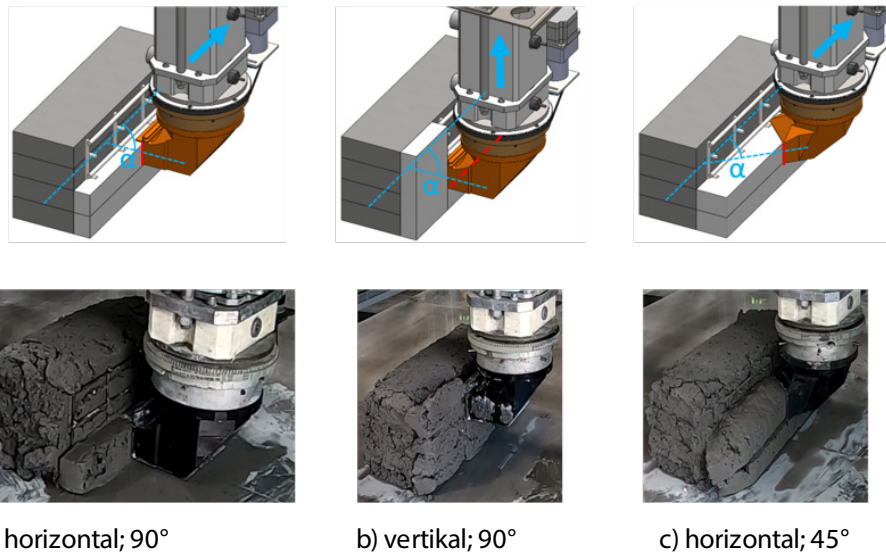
Variante 1 - Druckrichtungen und Düsenstellung beim Betonüberdeckungsdruck [26];[27]
